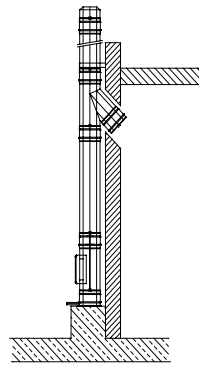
Aufbau mit Grundplatte für Sockelmontage
